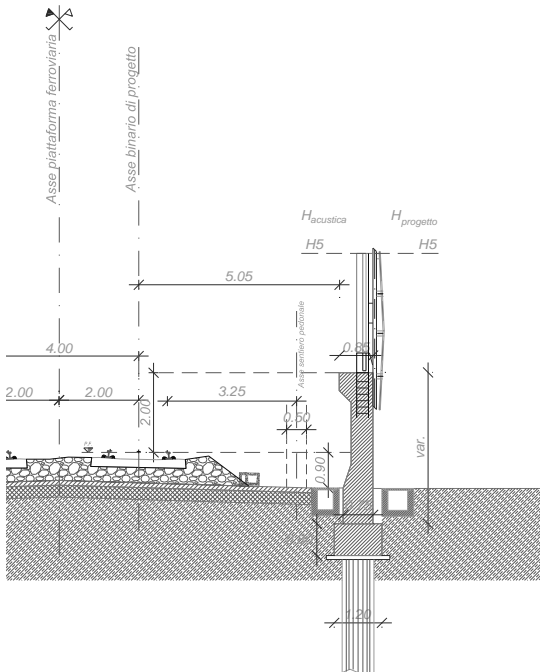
Sezione tipo tipologica BA “HS” rettificato senza manufatto prefabbricato fondato su Ods
